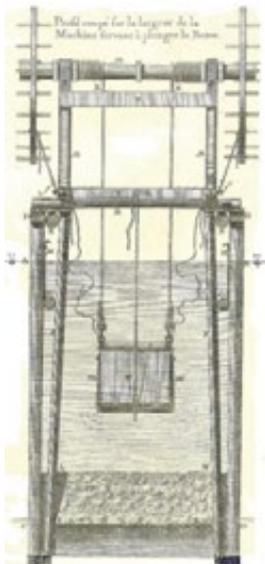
Fondation par encaissement par un batardeau étroit (extrait d'Architecture Hydraulique, de Belidor, tome II de 1737)
